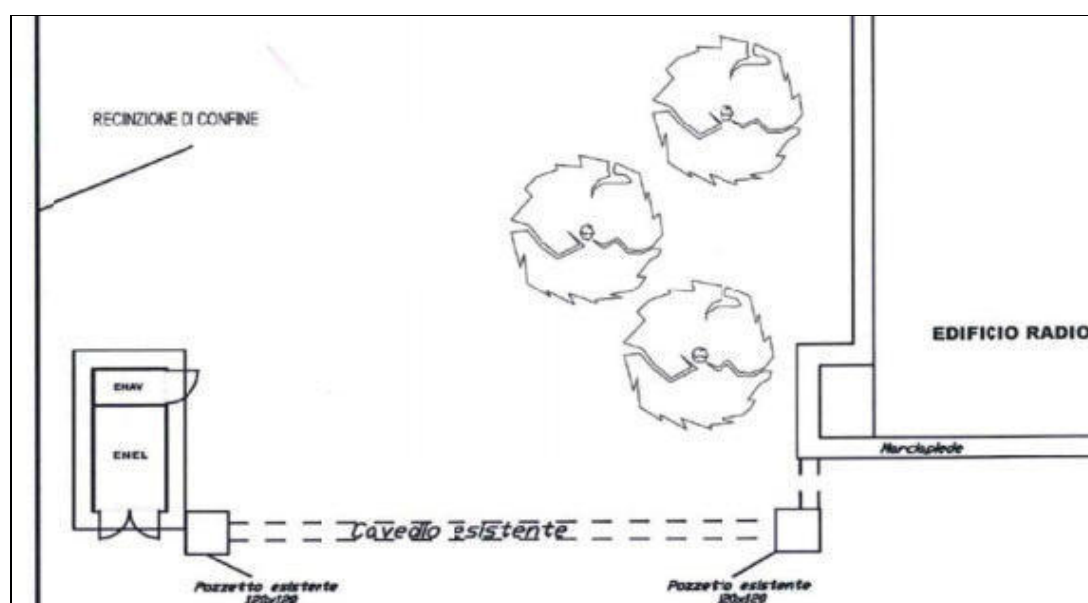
cabina elettrica esistente (schema planimetrico)
